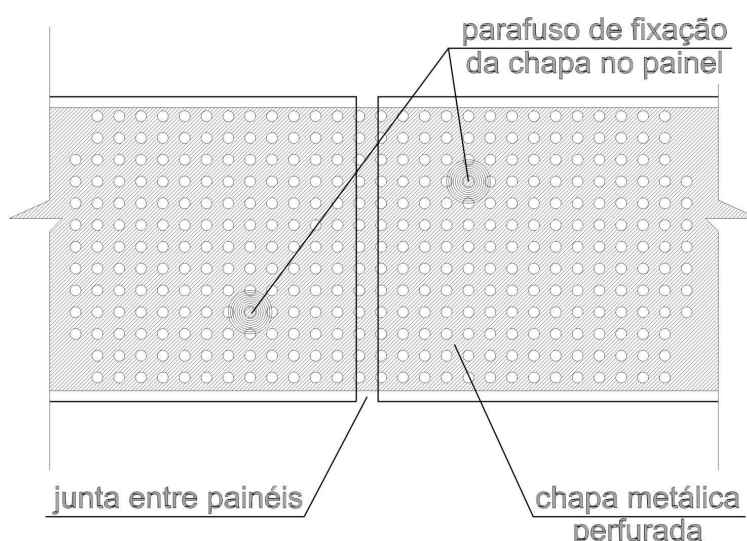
17: detalhe da fixação dos painéis de parede com chapa metálica perfurada.
